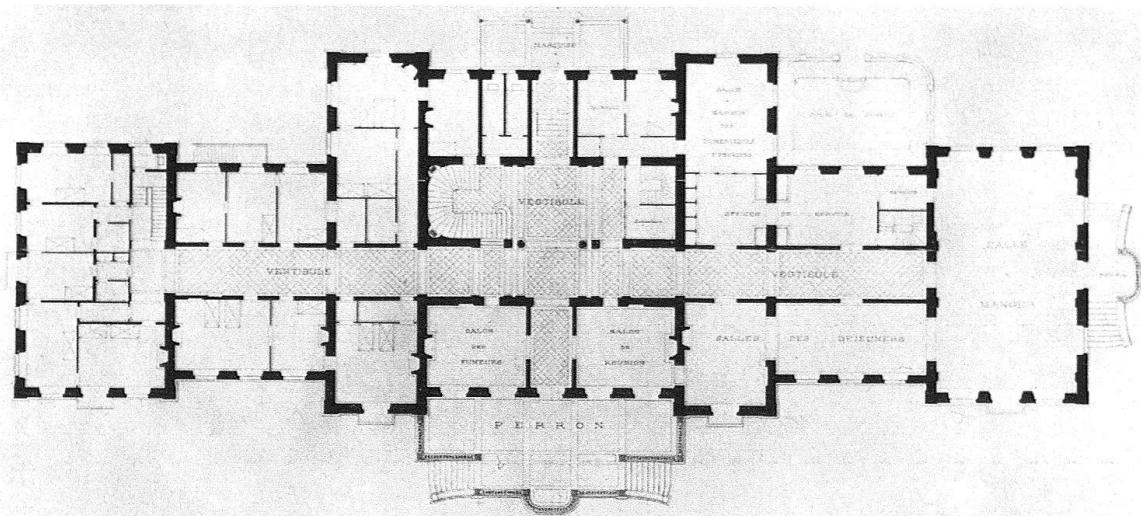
Morges. Hôtel du Mont Blanc, plan du rez-de-chaussée
